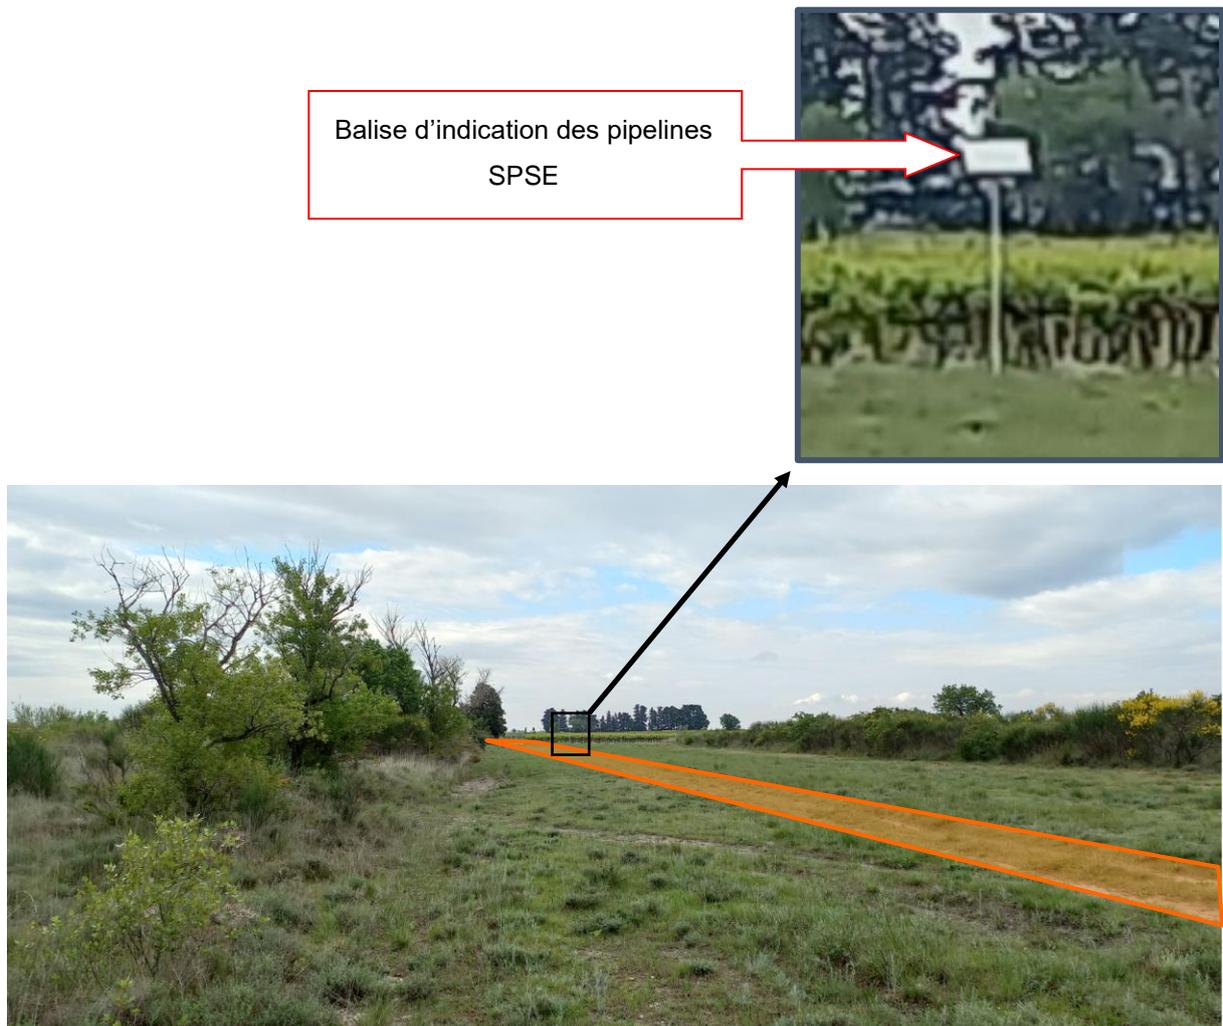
Illustration de la voie d'accès au site des travaux (Point A sur la carte de localisation figure 36)
